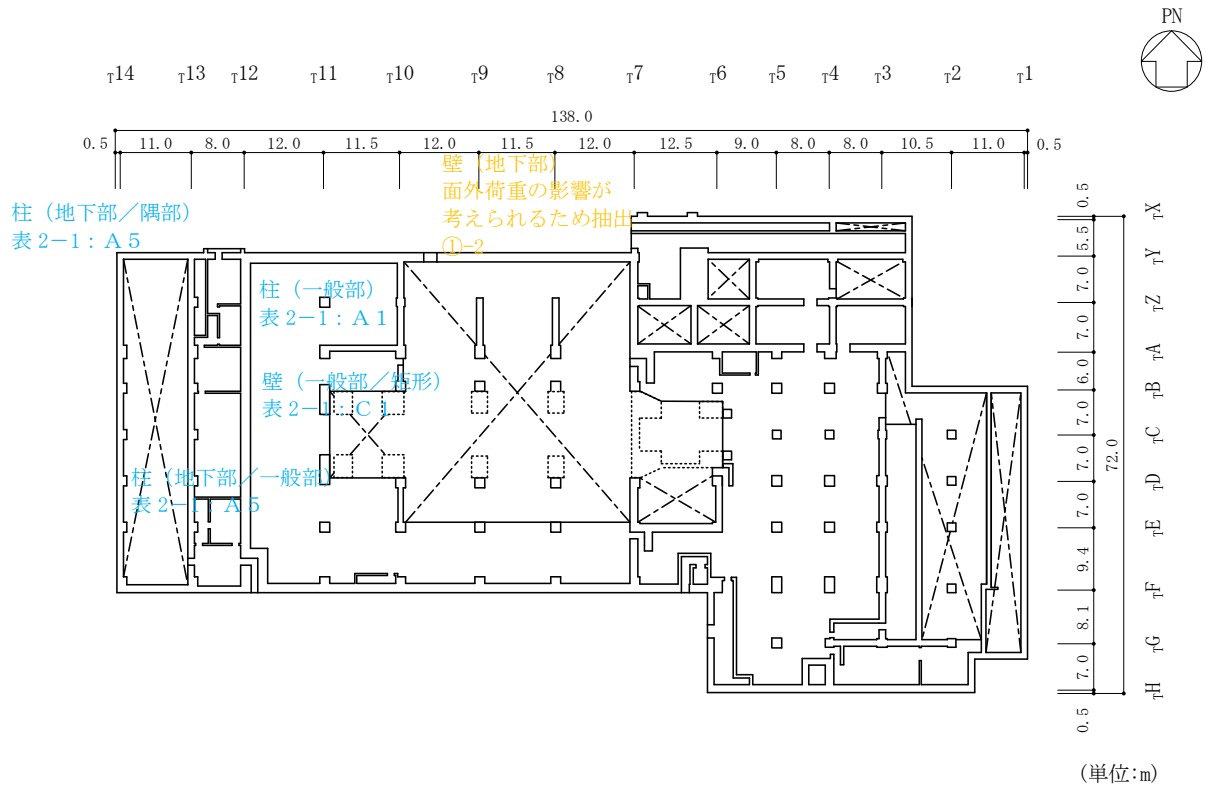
(2) タービン建物の概略平面図 (EL 5.5m)
